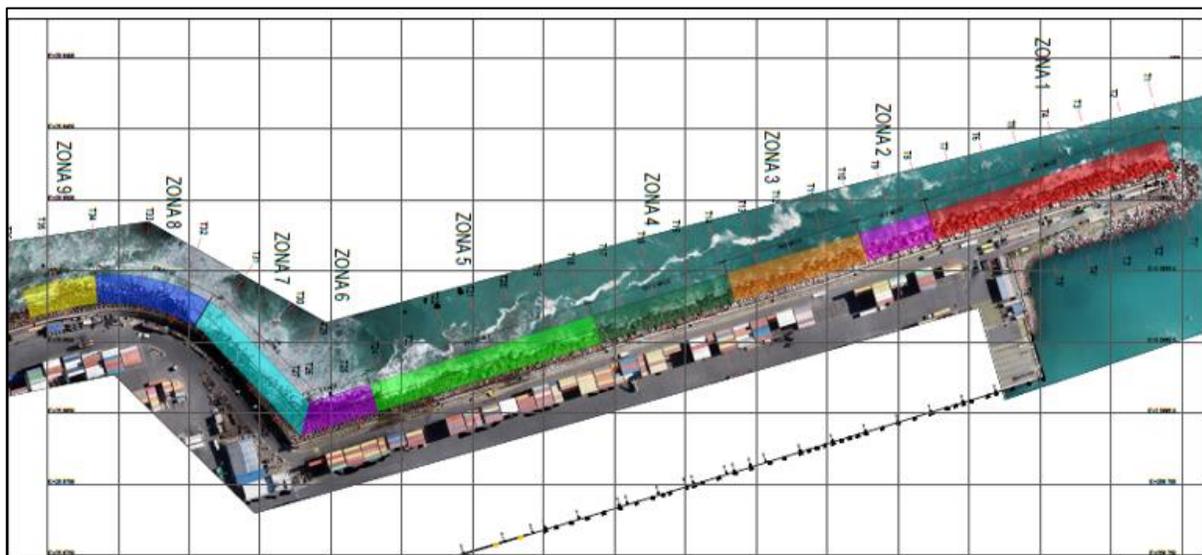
Planta de Zonas Molo Sur, Puerto San Antonio.
